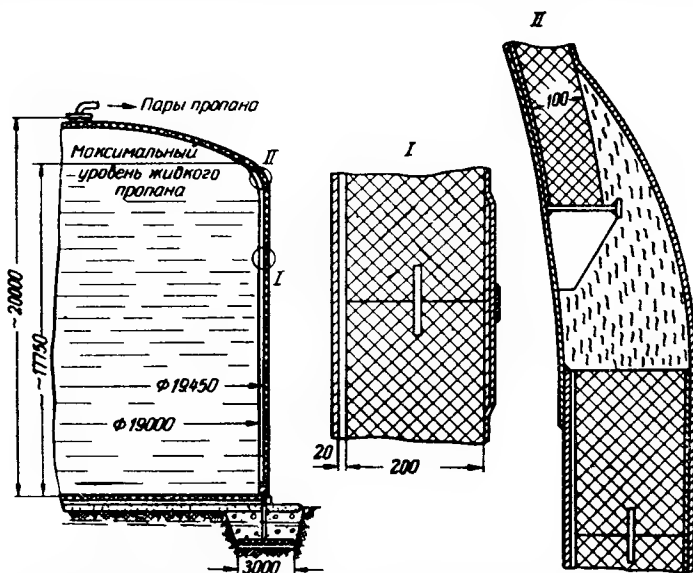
Установка резервуара на фундамент и теплоизоляцию
